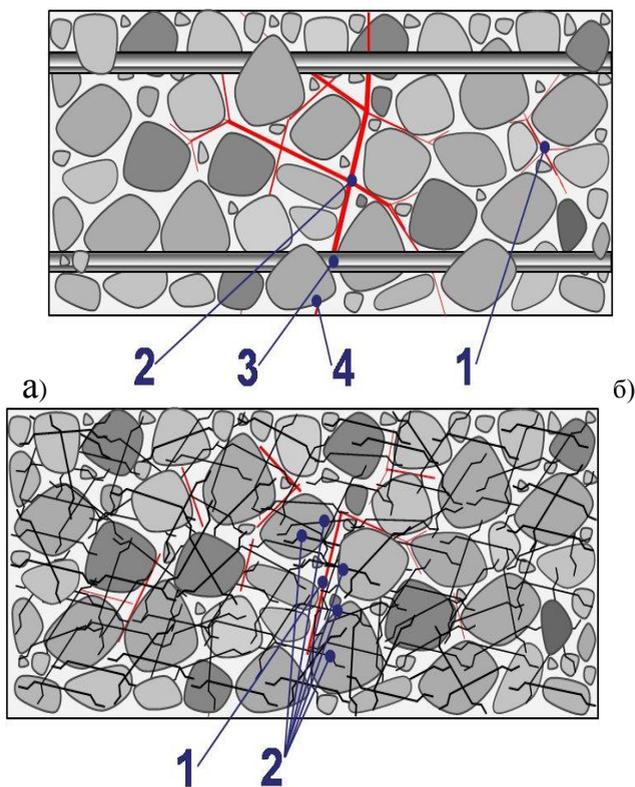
Схема появления микротрещин: а – традиционное армирование: 1 – появление микротрещин в неармированной зоне; 2 – распространение микротрещин возрастает и приводит к появлению макротрещин; 3 – пересечение зоны армирования макротрещинами; 4 – выход трещины на поверхность; б – сталефибробетон: 1 – появление микротрещины; 2 – перекрытие микротрещины фибрами
